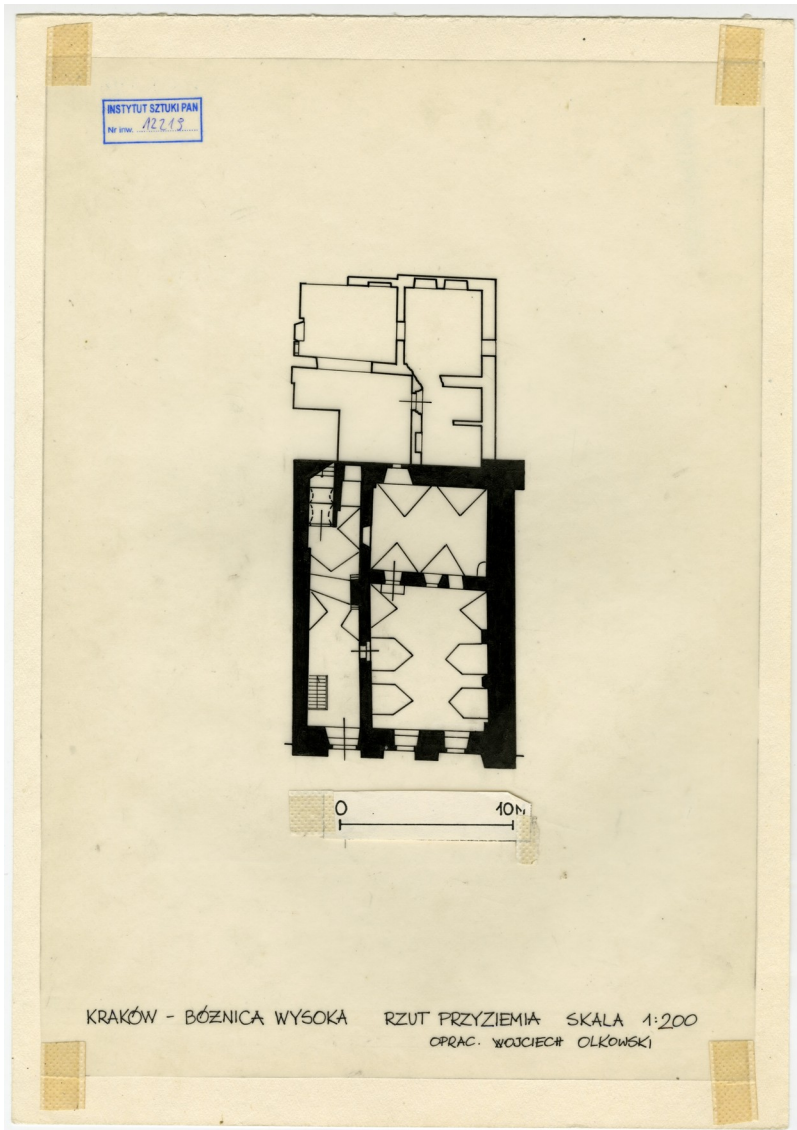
Grundriss EG, 1960er Jahre
